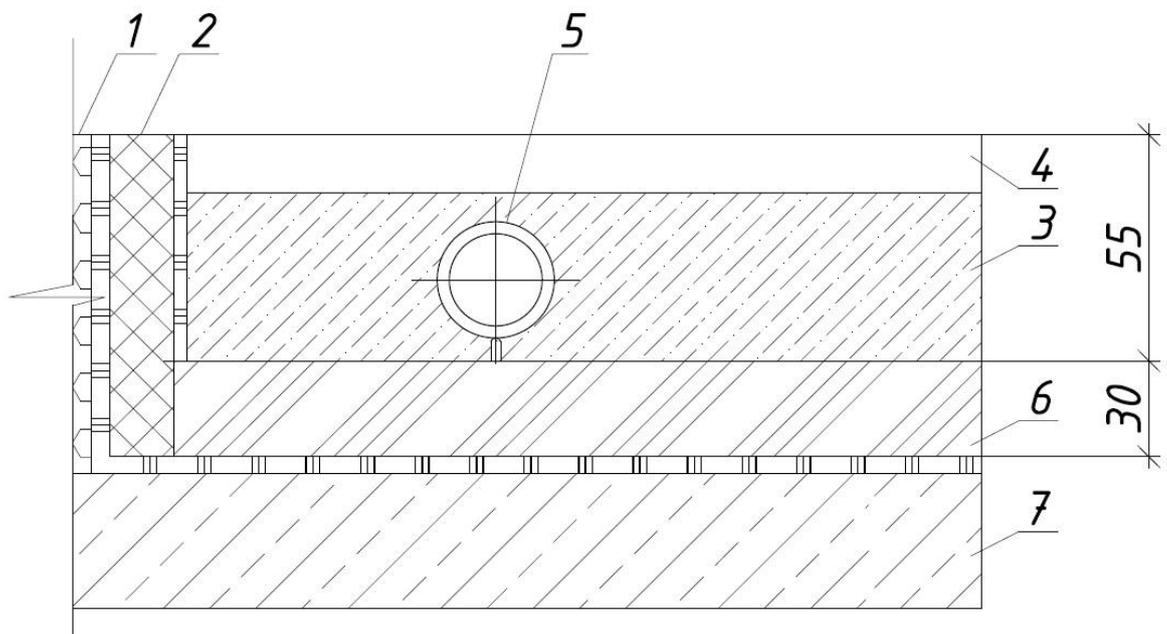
Разрез проложенных труб теплого пола: 1 – стена, 2 – компенсационная лента, 3 – слой бетона, 4 – арматурная сетка, 5 – греющий контур, 6 – тепловая изоляция, 7 – основание пола.
